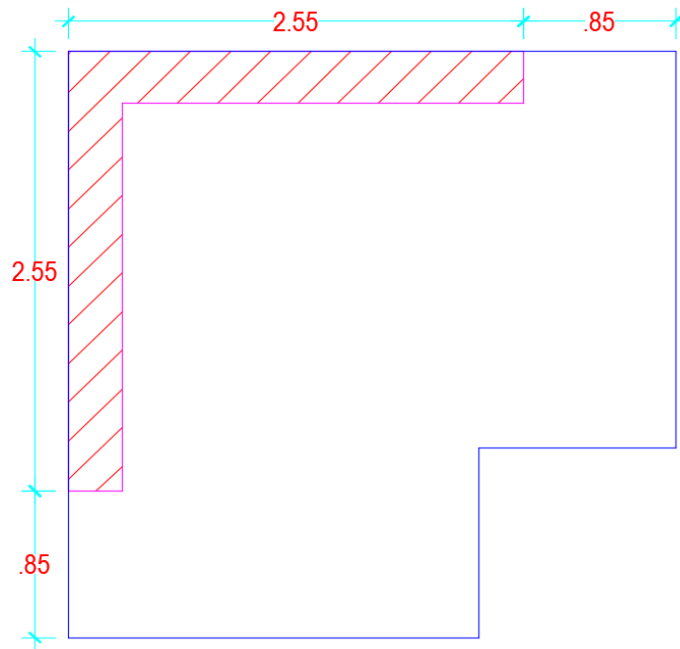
Plano final de la zapata bajo la placa P1. AutoCAD.
